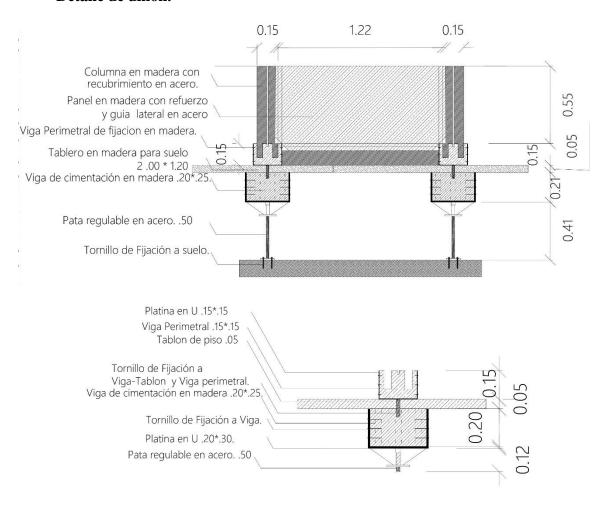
Detalle constructivo viga en madera y tablero en madera.
